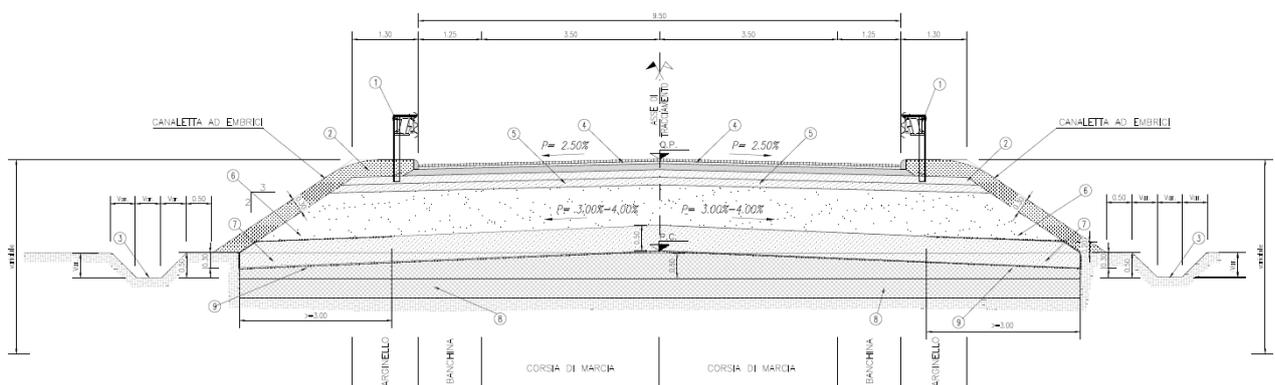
Sezione tipo di Progetto - Categoria C2 extraurbana secondaria
